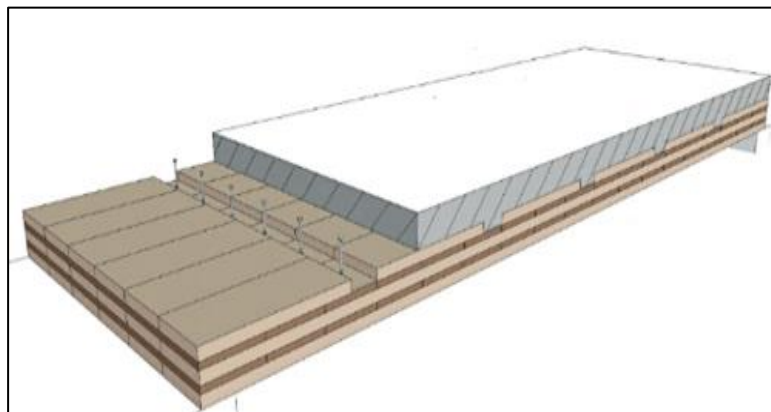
Sistema construtivo de CLT e betão [20]
